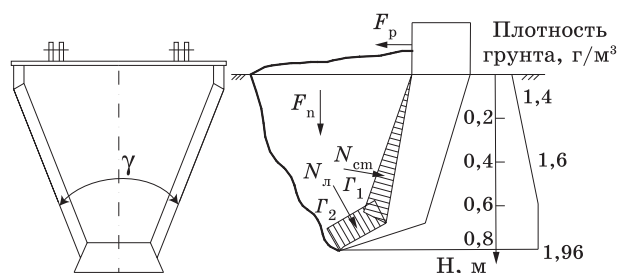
Схема рабочего органа рыхлителя к расчету усилий
